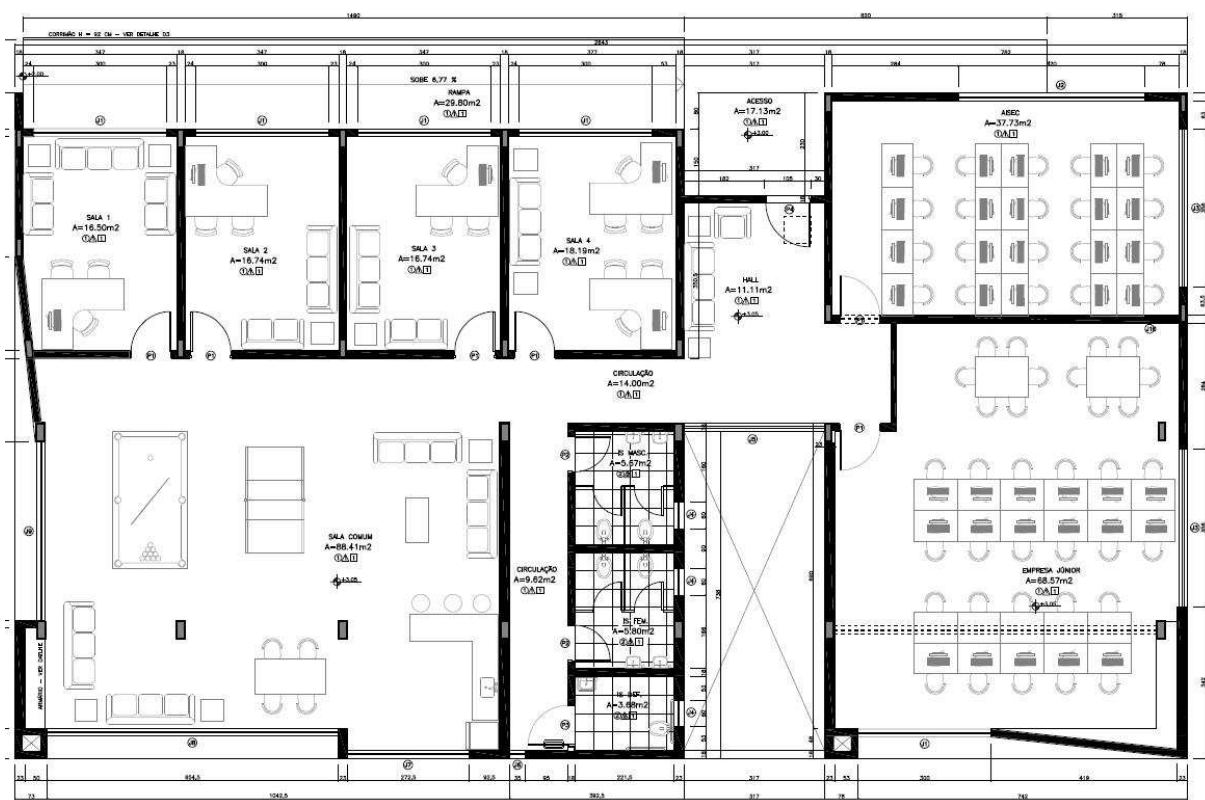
PLANTA BAIXA DA OBRA 1
